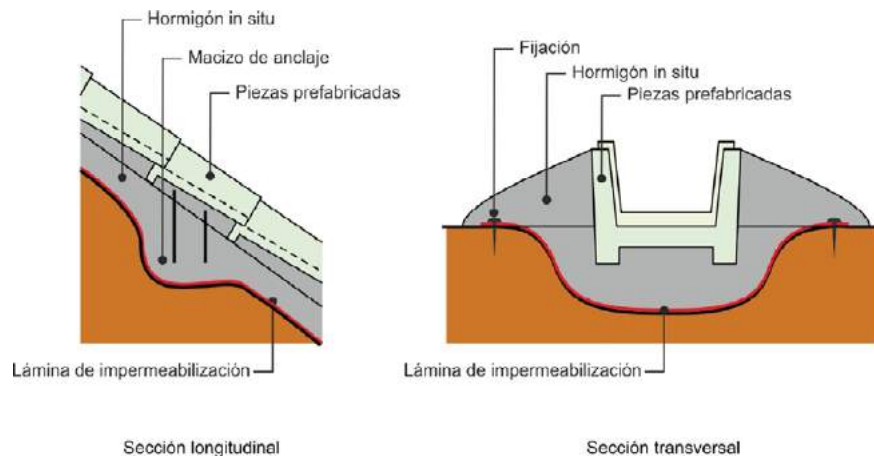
BAJANTE CON LÁMINA DE IMPERMEABILIZACIÓN
